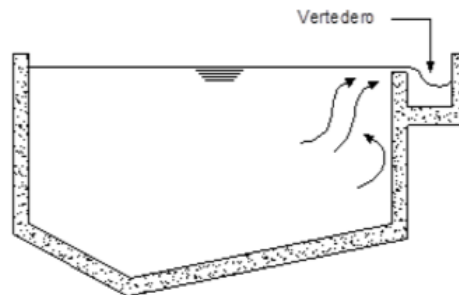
Esquema de la tolva de arenas – planta
